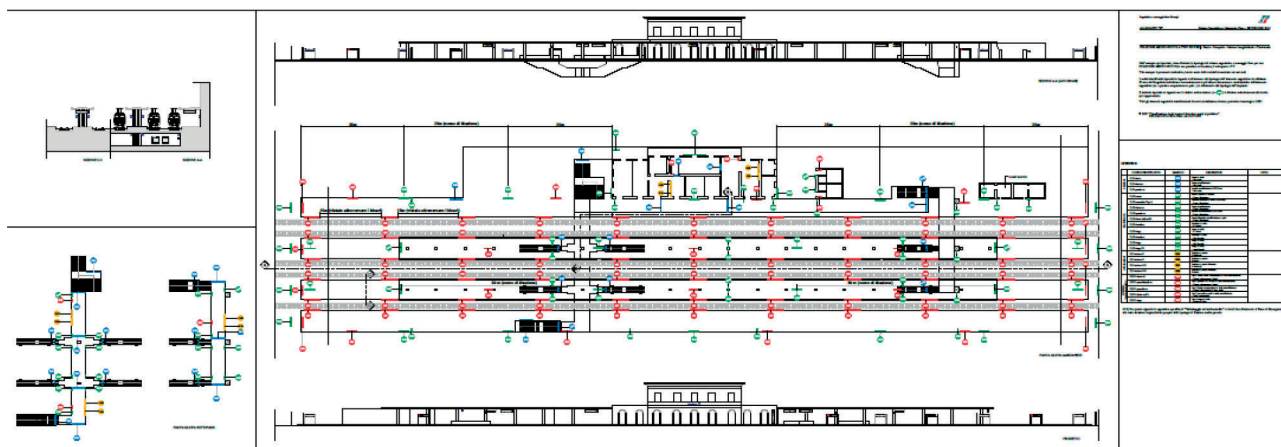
“Allegato B” al Sistema Segnaletico a Messaggio Fisso - Revisione 2013 – esempio progettuale. Stazione medio piccola tipo SILVER: piante - prospetto - sezione longitudinale e trasversale con rappresentati tutti gli elementi segnaletici necessari alla stazione. Sulla destra della figura vengono riportati i codici identificativi che si riferiscono alla tipologia dell'elemento segnaletico da utilizzare.
